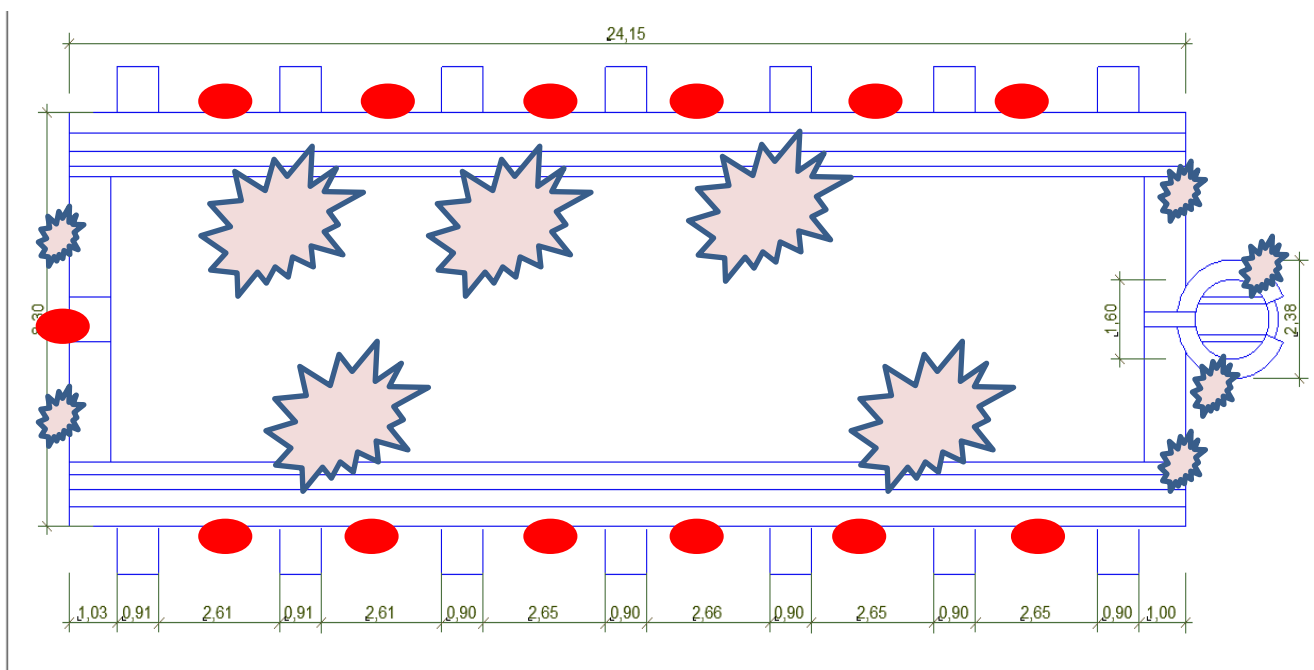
'etat de lieux de djoub boutrikfin dans plan fait par l'auteur
